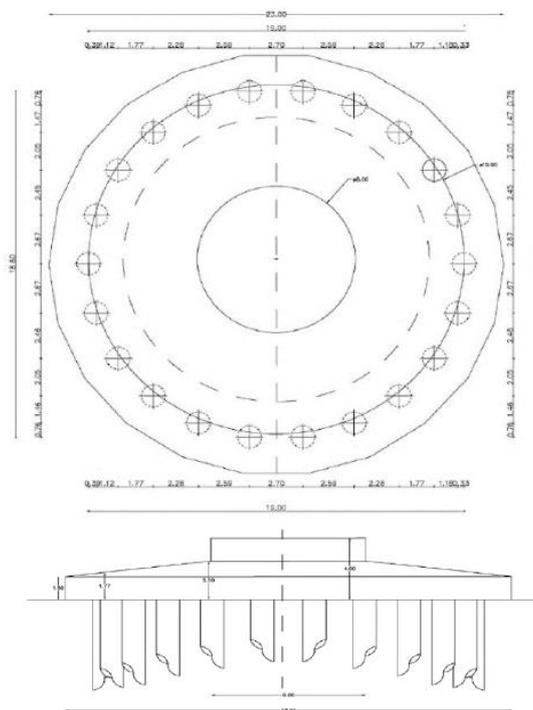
Pianta e prospetto della fondazione dell'aerogeneratore
